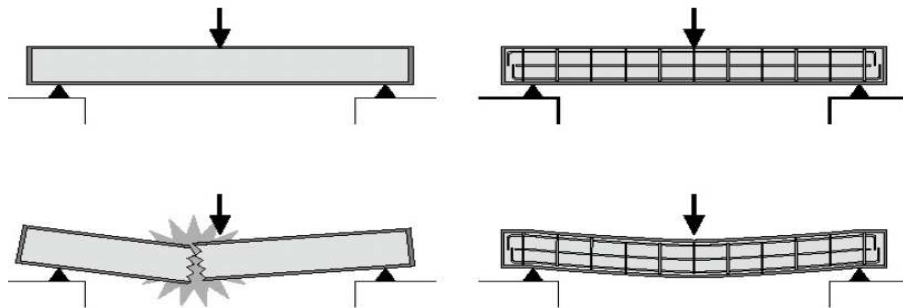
Ejemplo de comportamiento de una viga con y sin refuerzo
